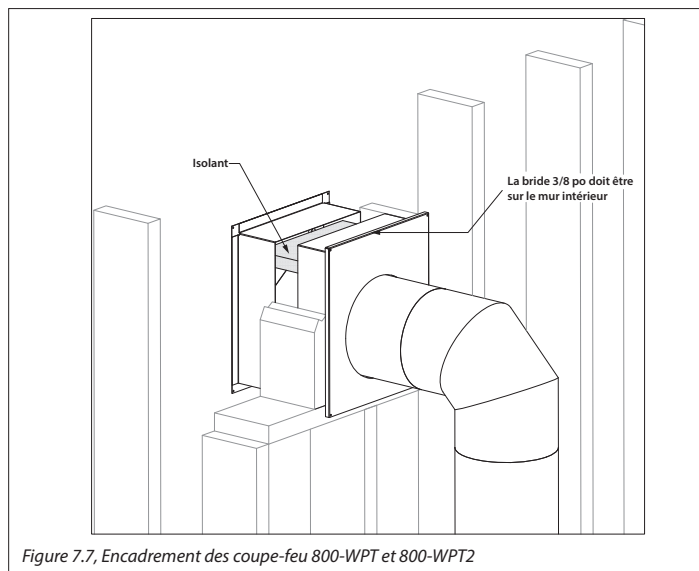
, Encadrement des coupe-feu 800-WPT et 800-WPT2
